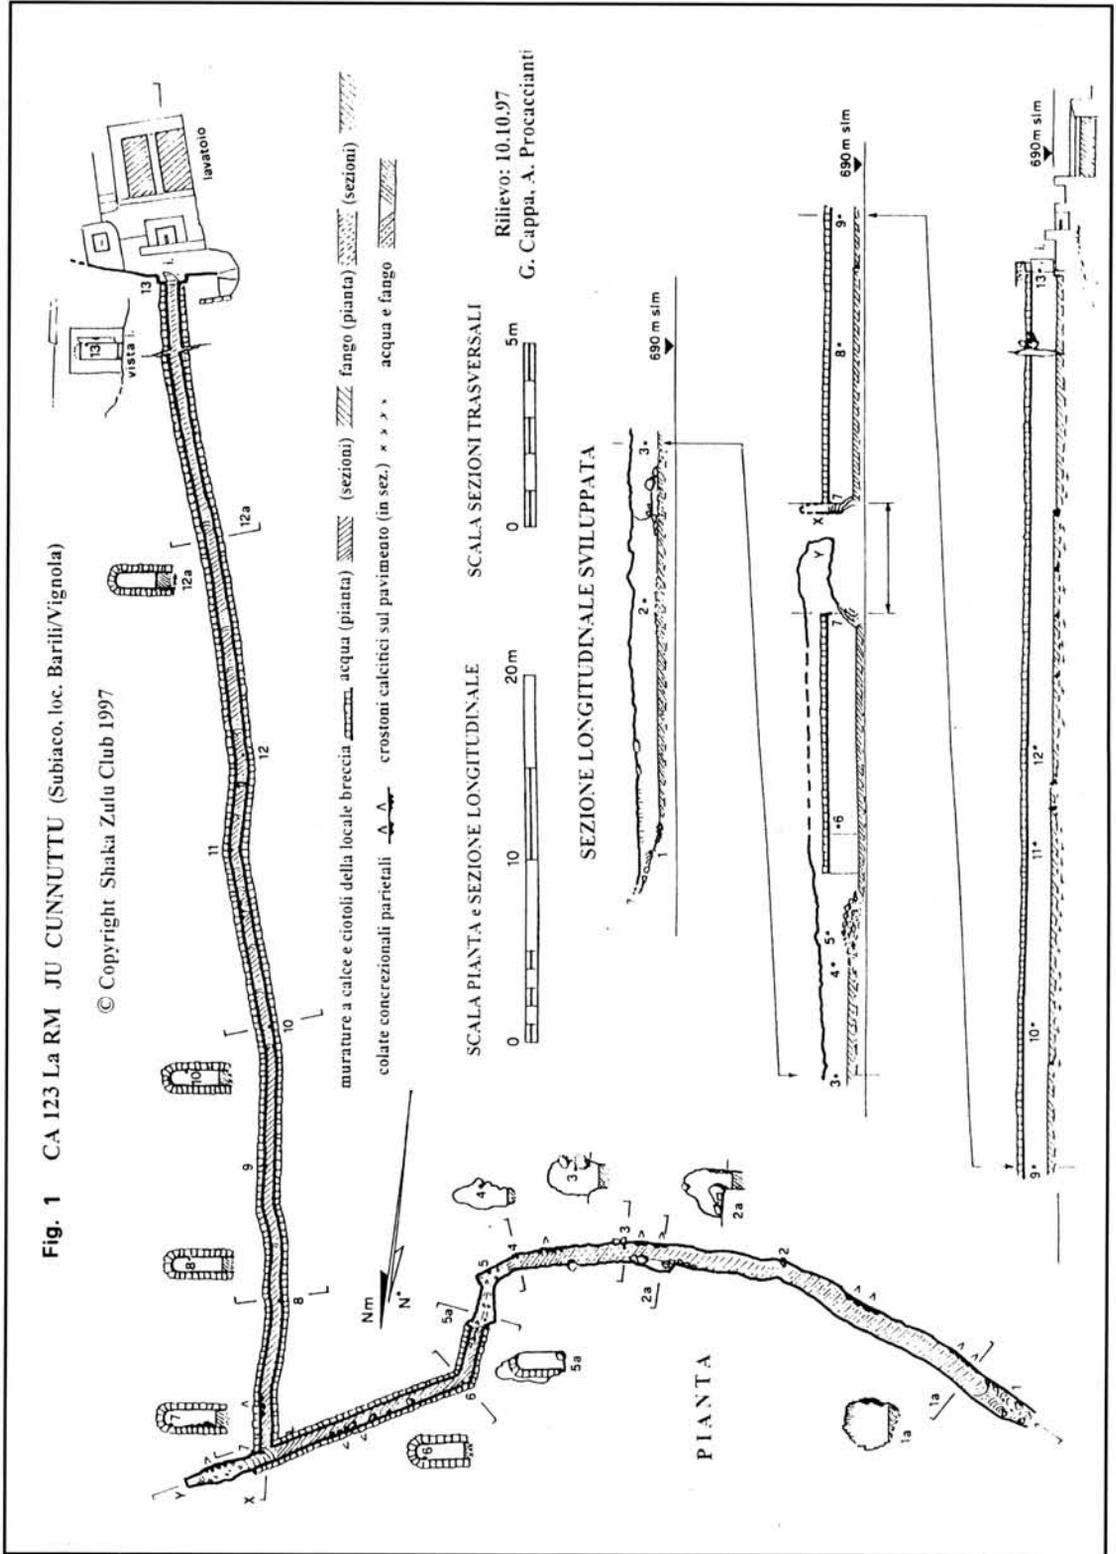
Pianta e sezioni dell'ipogeo "Ju cunnuttu" (il condotto).
